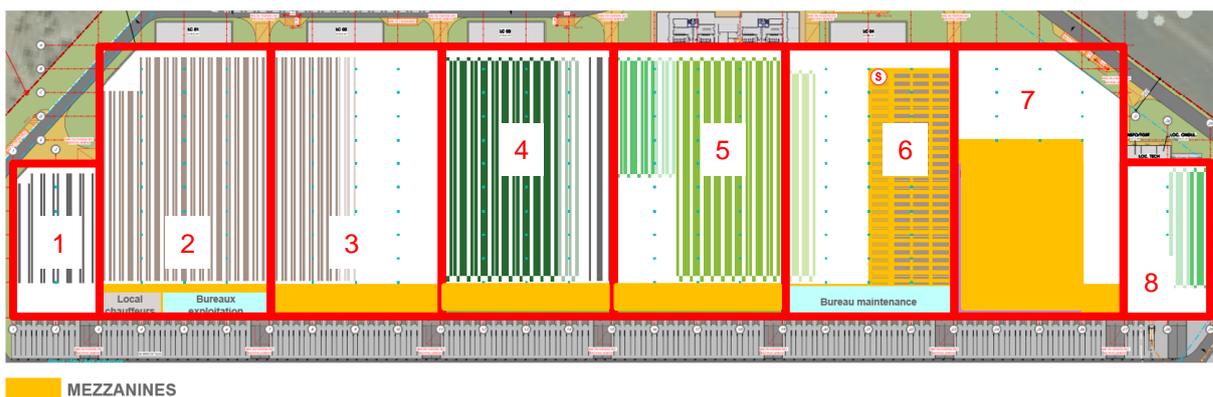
Plan de l'étage R+1 de la mezzanine
